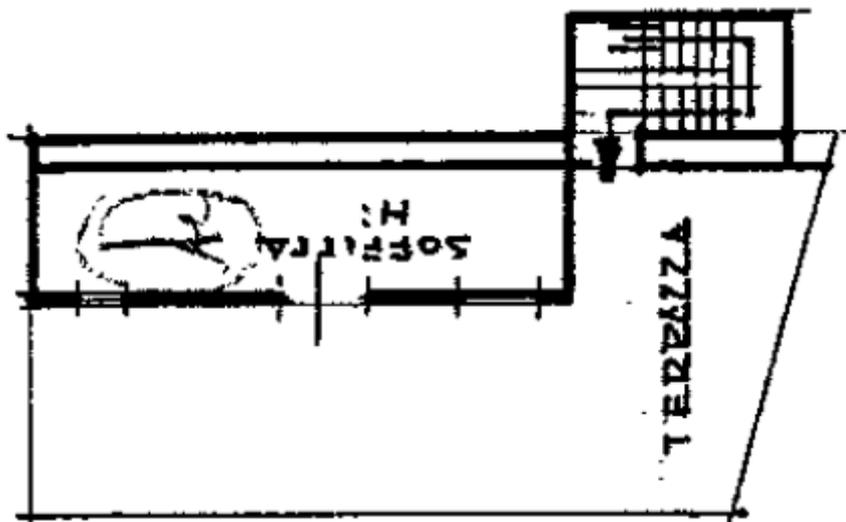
Planimetria catastali dei beni, sub. 1 (p.3).
